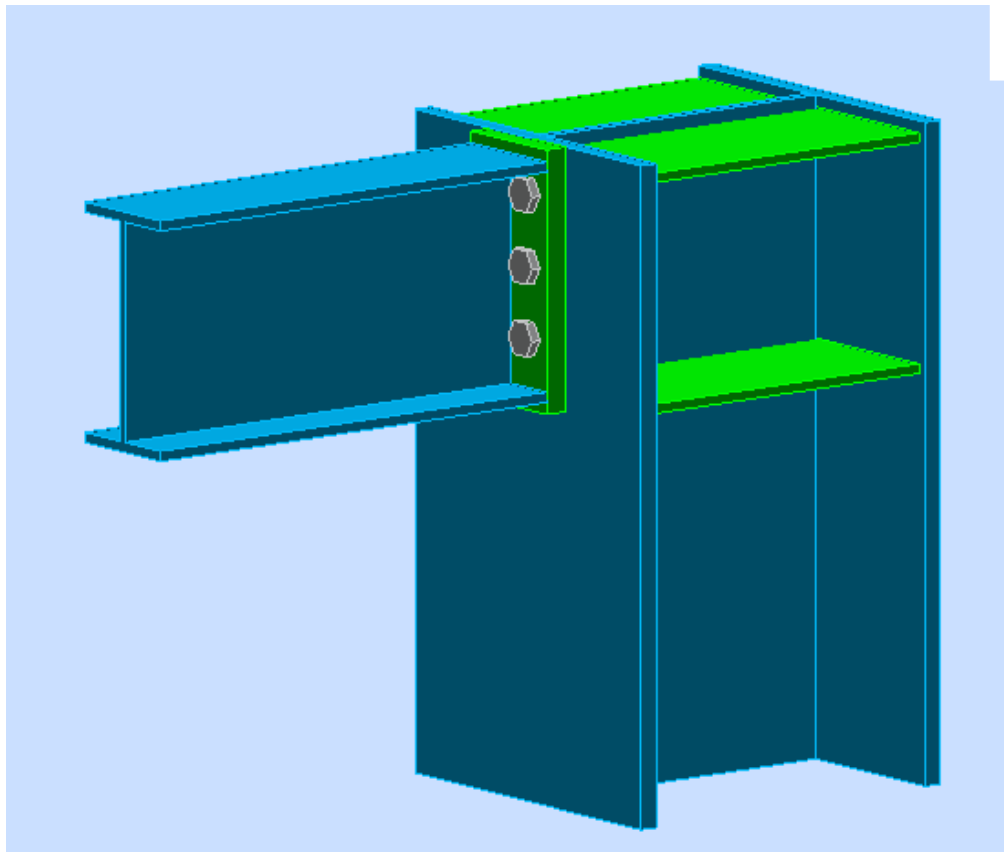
Vue de l'assemblage poteau - poutre secondaire.
